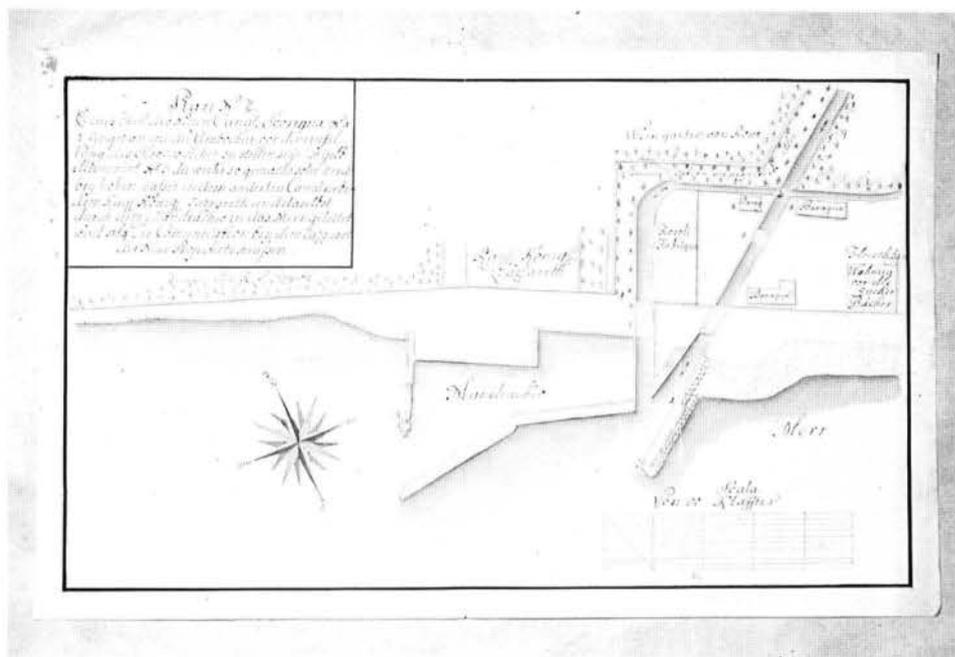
Il cosiddetto Piano num. 2 (de Bonomo), DAR, Collezione di planimetrie, num. 227.
